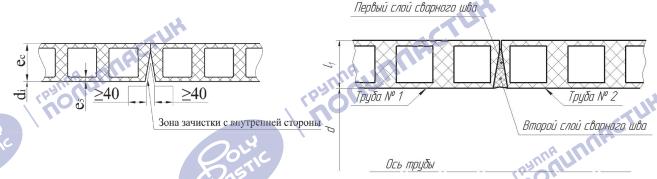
Зона зачистки труб «СПИРОЛАЙН» при проведении сварочных работ внутри свариваемых труб
